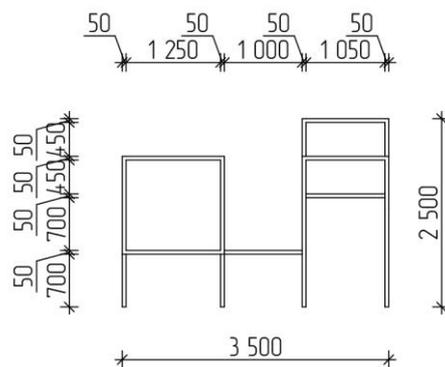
Чертеж разминочного лаза. Вид сбоку
